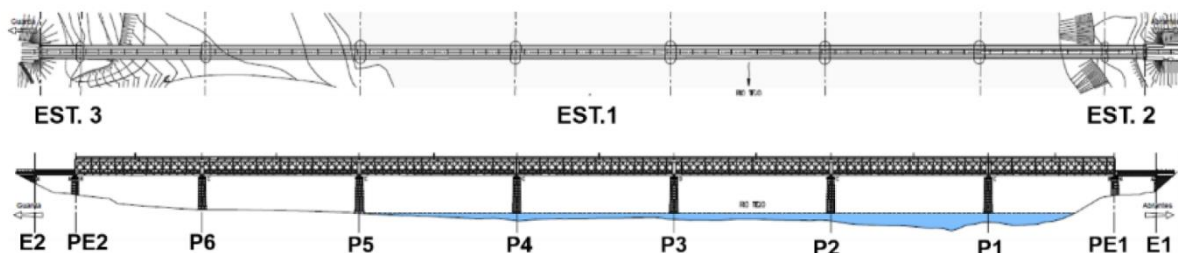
Esquema estrutural da Ponte do Tejo na Linha da Beira Baixa
